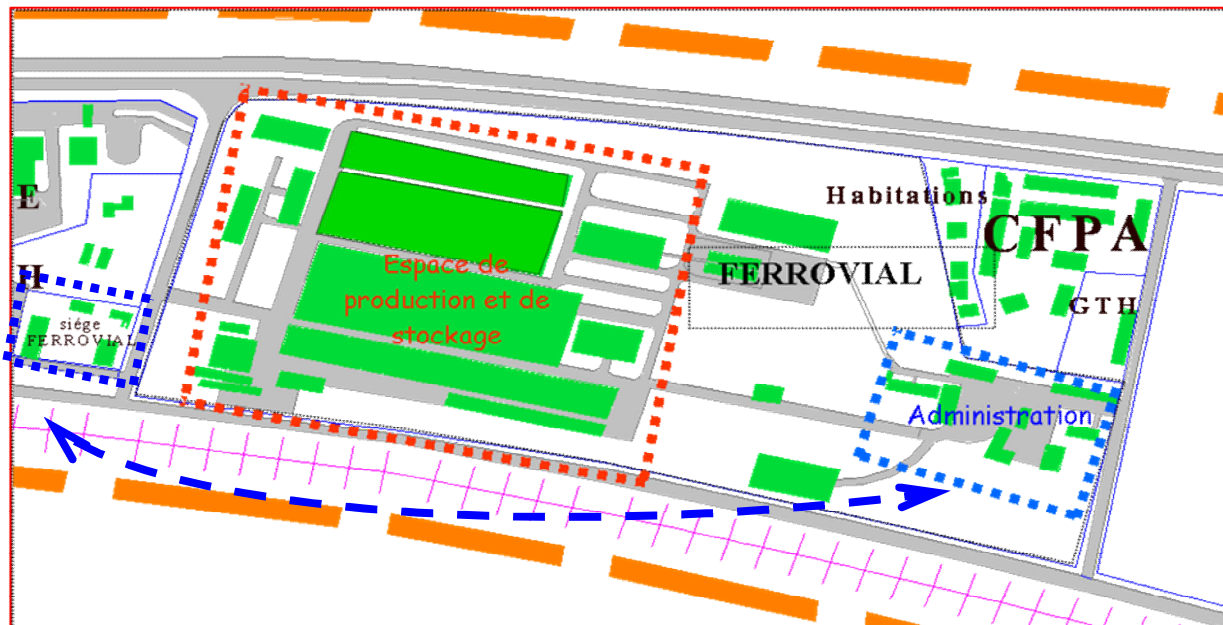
Plan de masse de l'entreprise FERROVIAL
